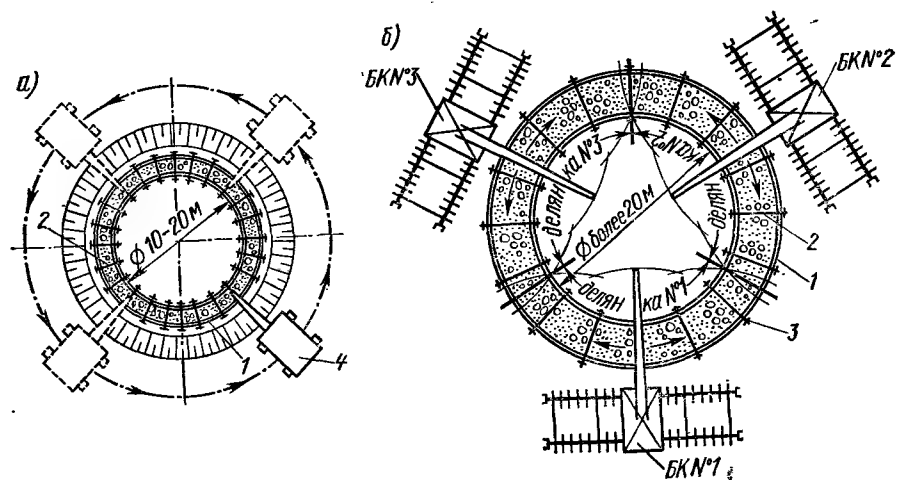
Бетонирование стен резервуаров и опускных колодцев: а — непрерывное послойное бетонирование; б — бетонирование по секторам (делянкам); 1 — опалубка; 2 — тяжи; 3 — вертикальное ребро жесткости; 4 — край-бетонукладчик
